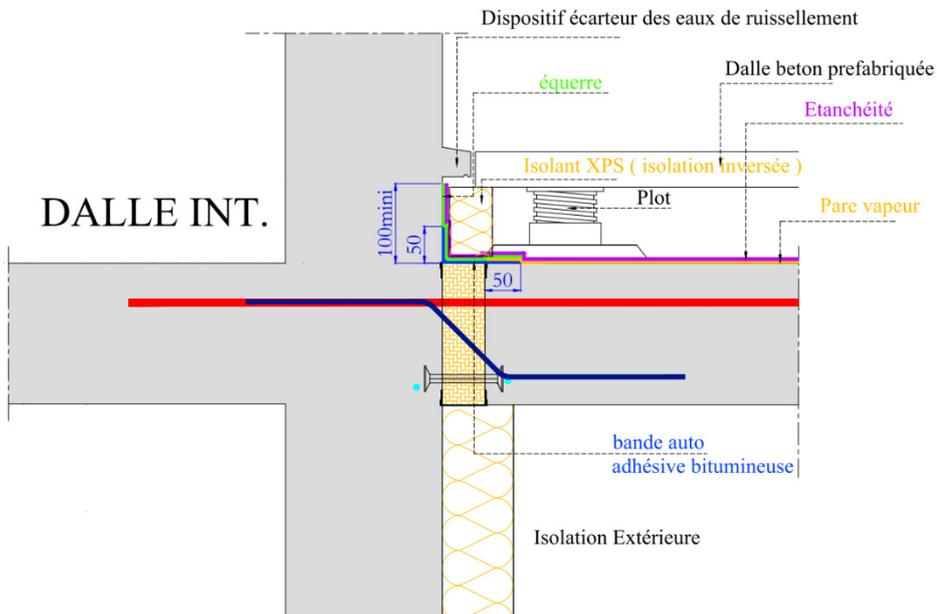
Modèle MVE, dalle sur plots avec isolation sous dalle sur plot
